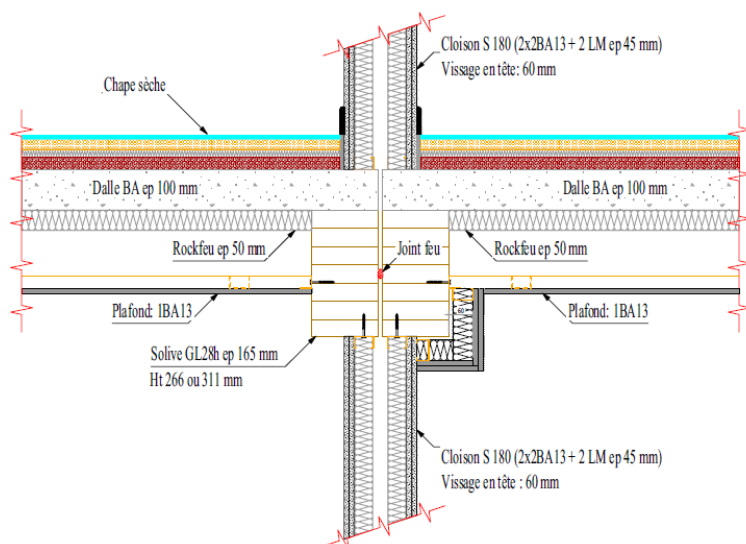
Coupe sur plancher ARBODAL® - ©Arbonis
